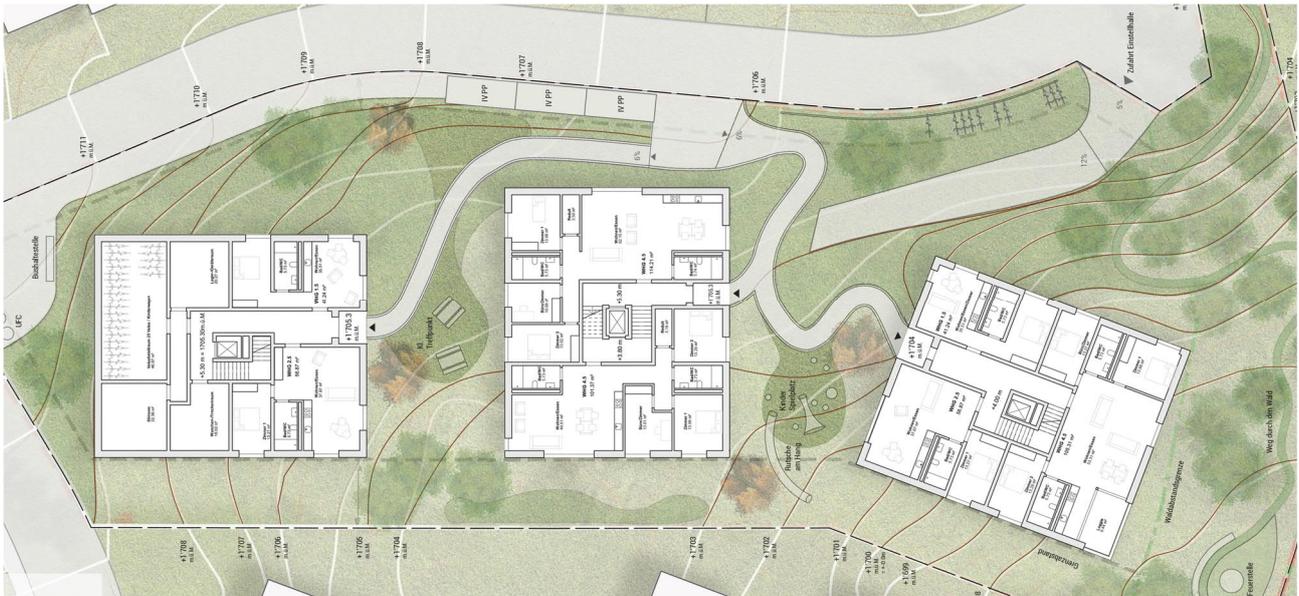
Erdgeschoss TIC TAC TOE (massstabslos)
